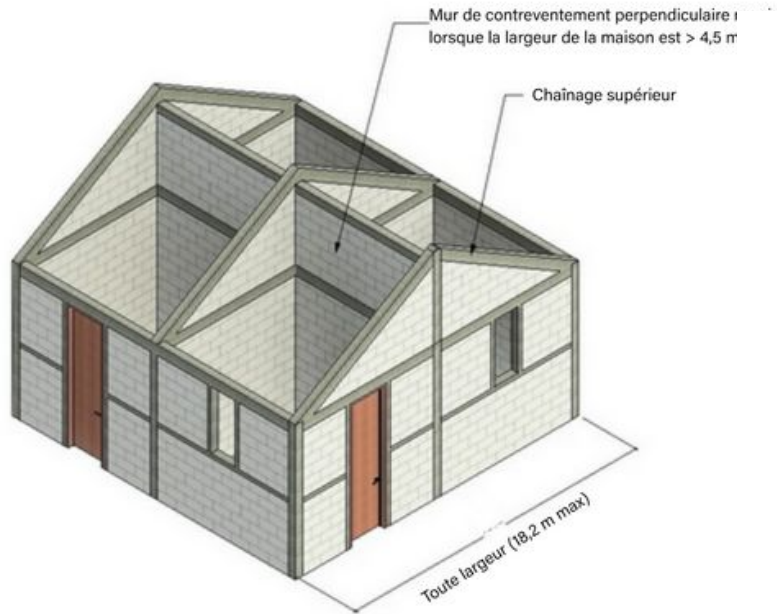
Renforcement des murs de toitures (2 barres)
